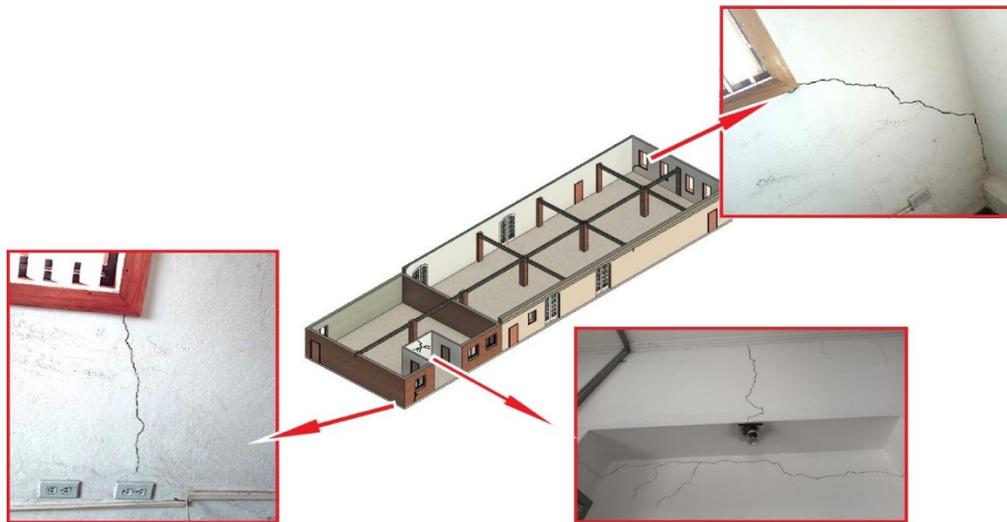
Casa 2. Detalle de fisuras en biblioteca municipal.
